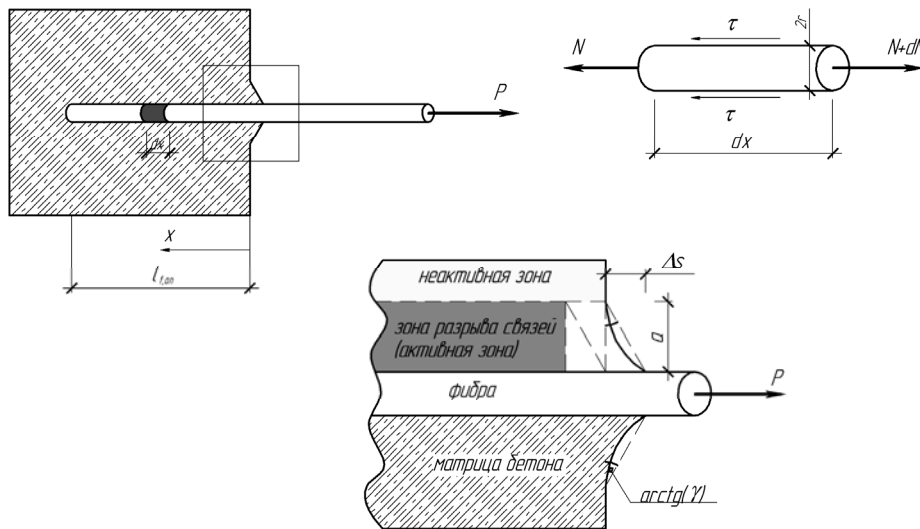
Схема нагружения гладкой фибры в матрице бетона
